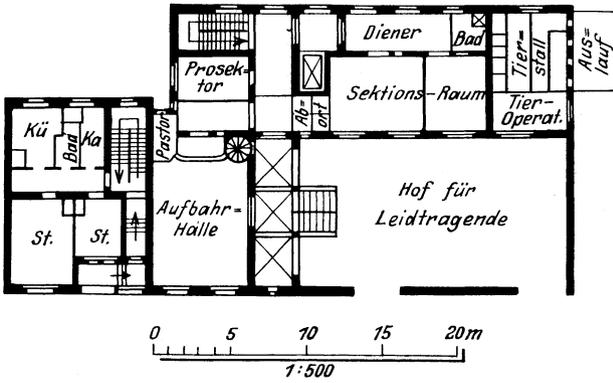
Berlin-Lichtenberg, städtisches Krankenhaus, Leichenhaus.
